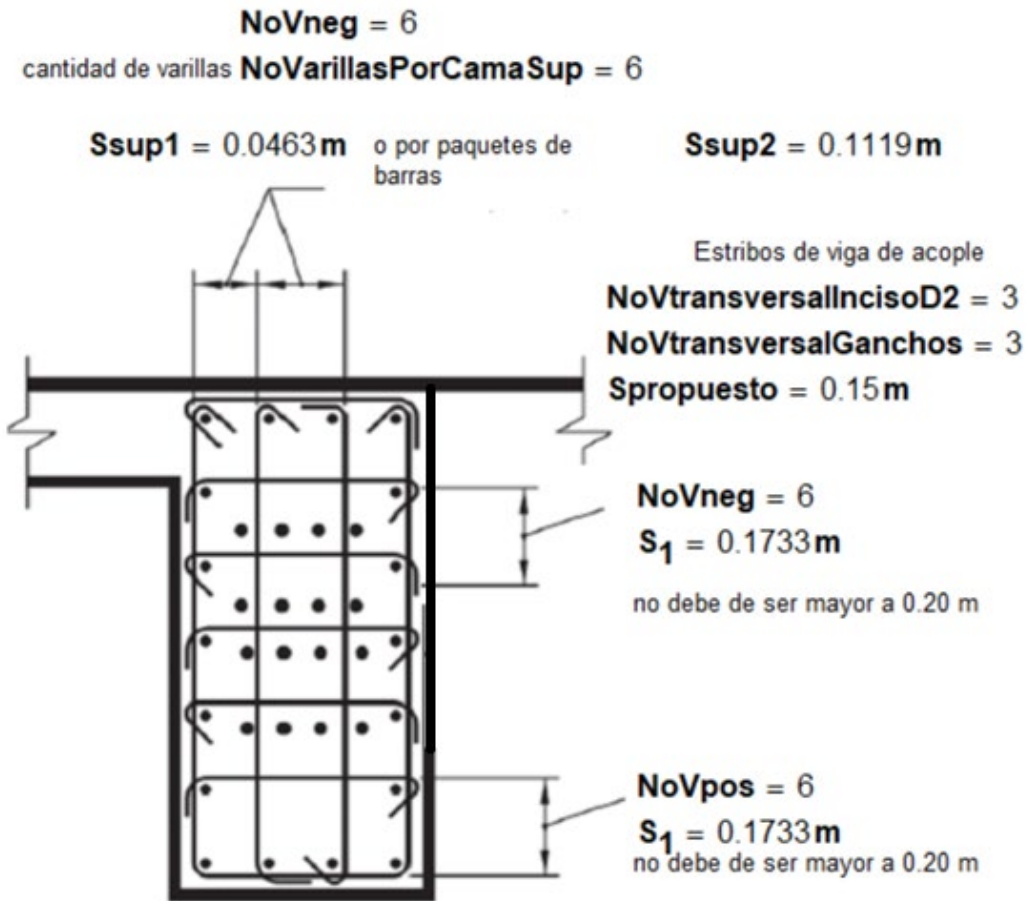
Detalle de refuerzo longitudinal superior viga de acople, ejemplar uno
